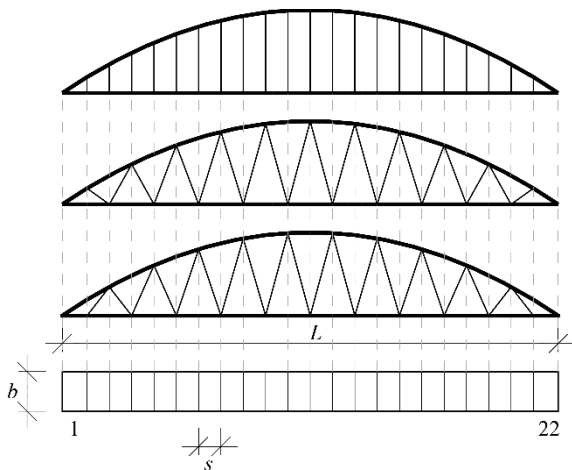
Vista en alzado de los tres modelos, y vista en planta del tablero, con las superficies correspondientes a las 22 cargas variables.
